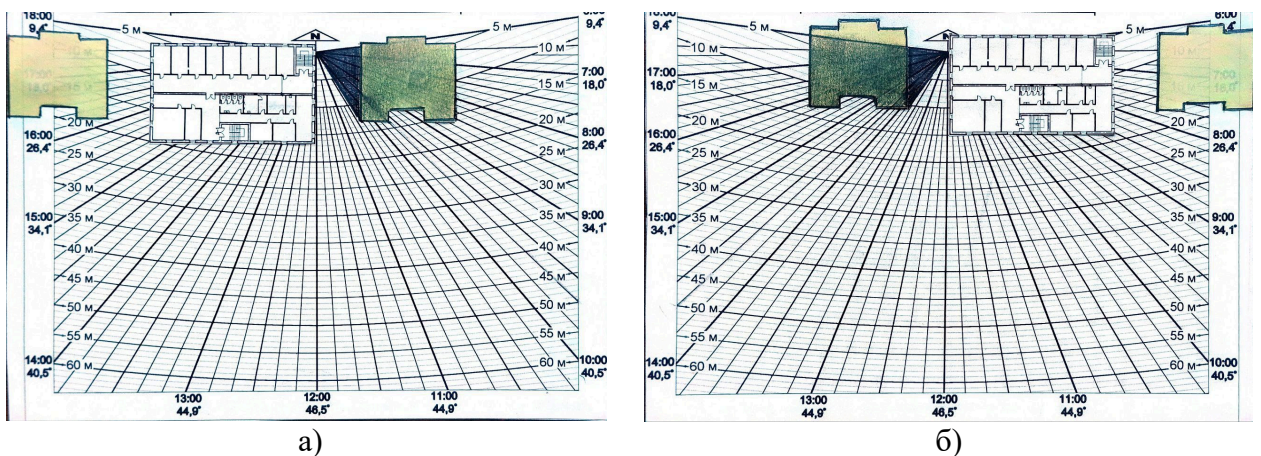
Инсоляционный график для здания: а) самое дальнее окно на восточном фасаде, б) самое дальнее окно на западном фасаде
